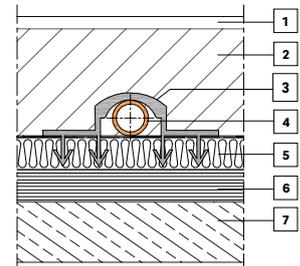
Prinzipaufbau System RAUTAC 10 mit Zusatzdämmung
